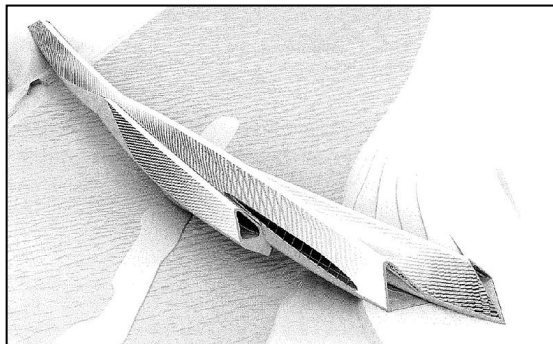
, Zaha Hadid, *Pavillion Bridge, Zaragoza, Espanha, 2008. Desenho.
